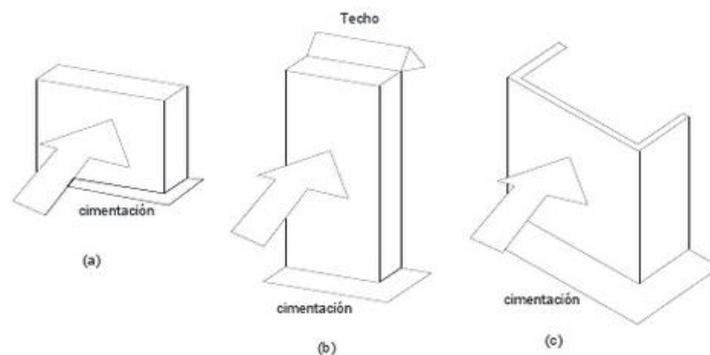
Comportamiento estructural de un muro ante cargas fuera del plano.
